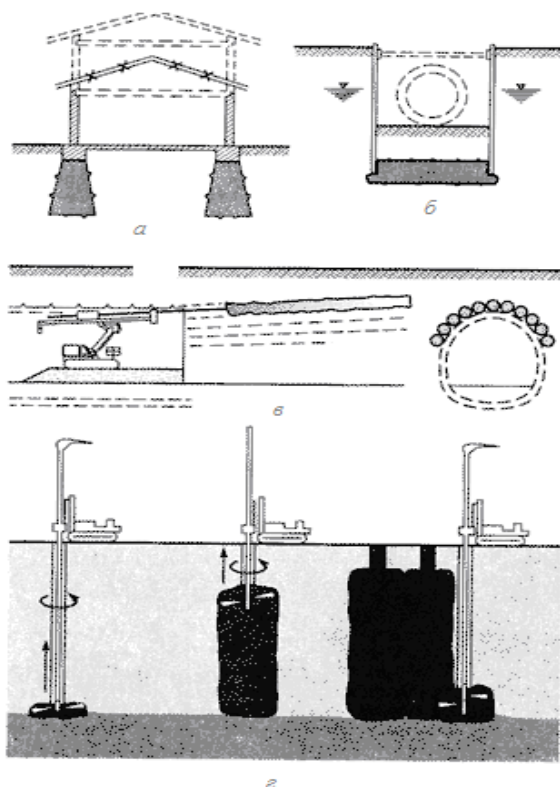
Варианты использования грунтовых свай в качестве: а - укрепления оснований фундаментов; б - защиты коммуникаций от грунтовых вод; в - защиты от обрушения грунта; г - шпунтового ограждения.
